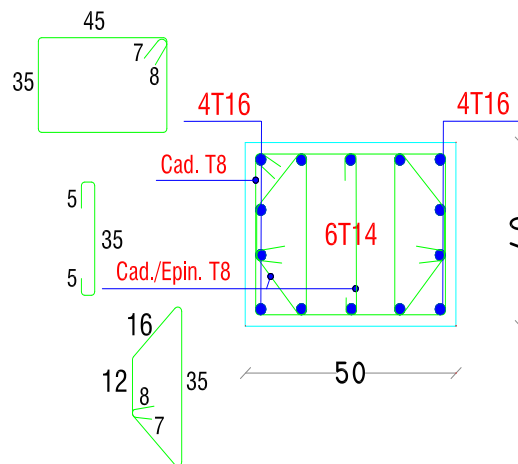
coupe Ferraillage des poteaux (50×40) cm<sup>2</sup>.
